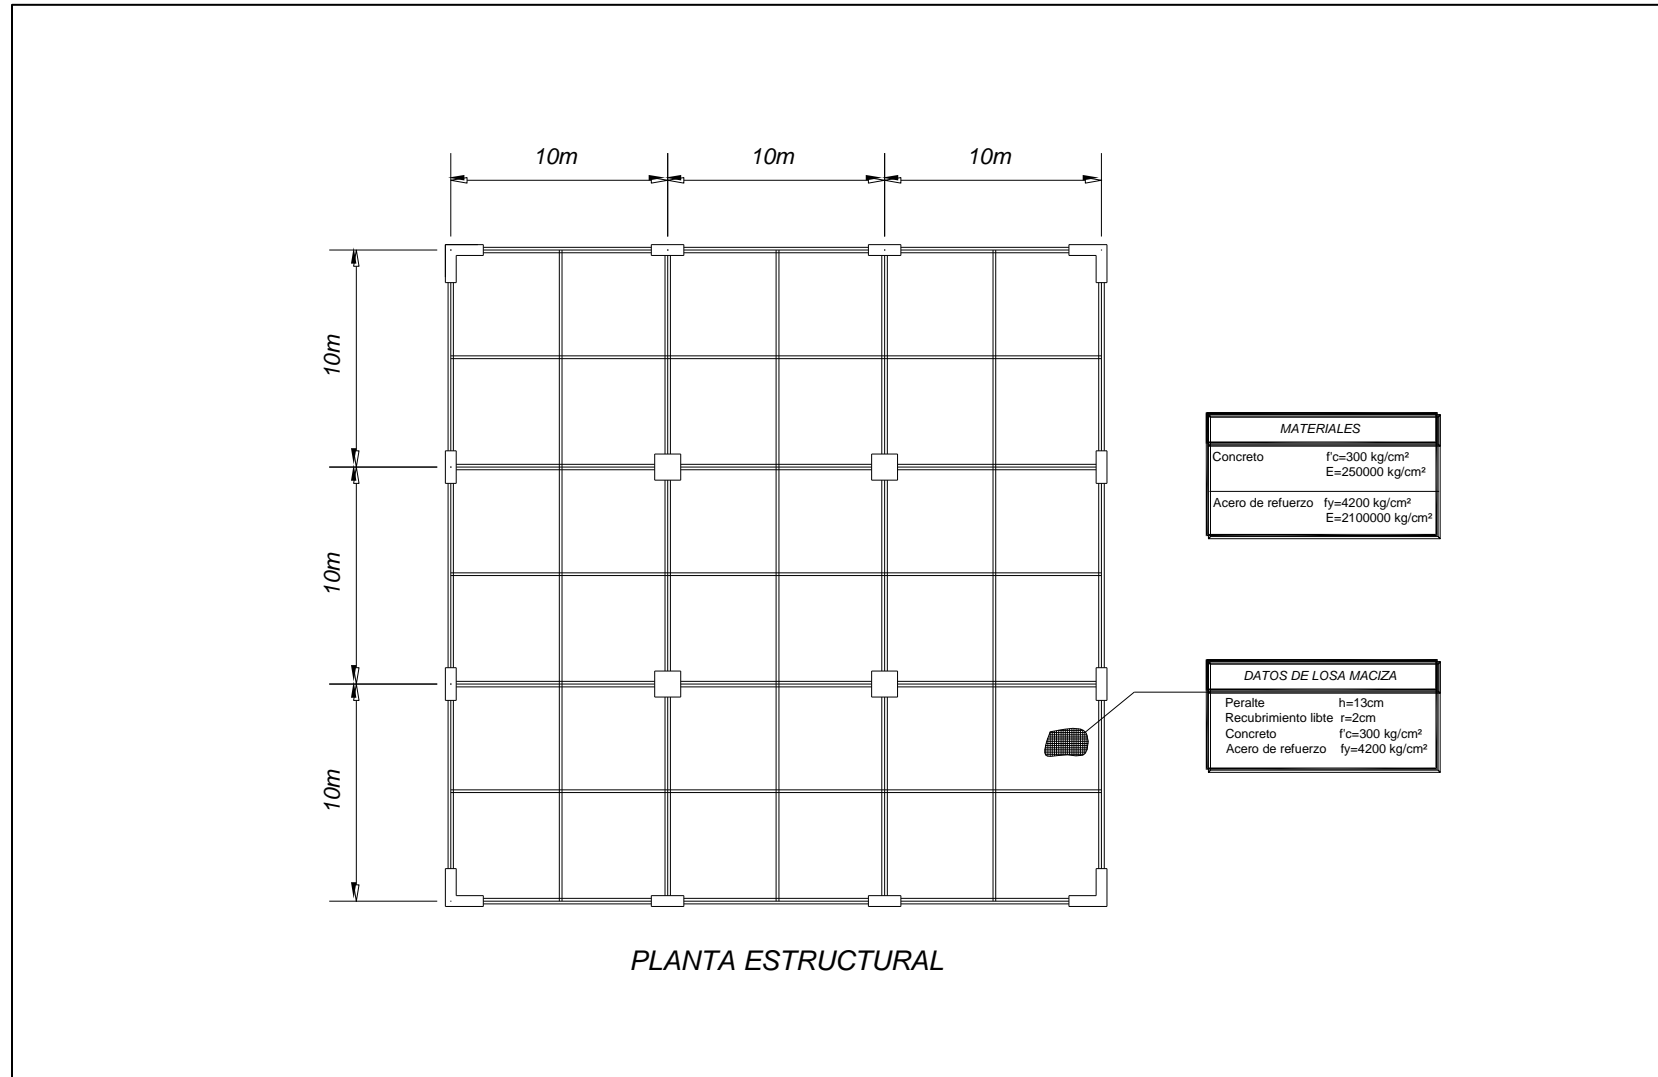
Detalles estructurales del edificio de 15 niveles diseñado con el ACI318-08
